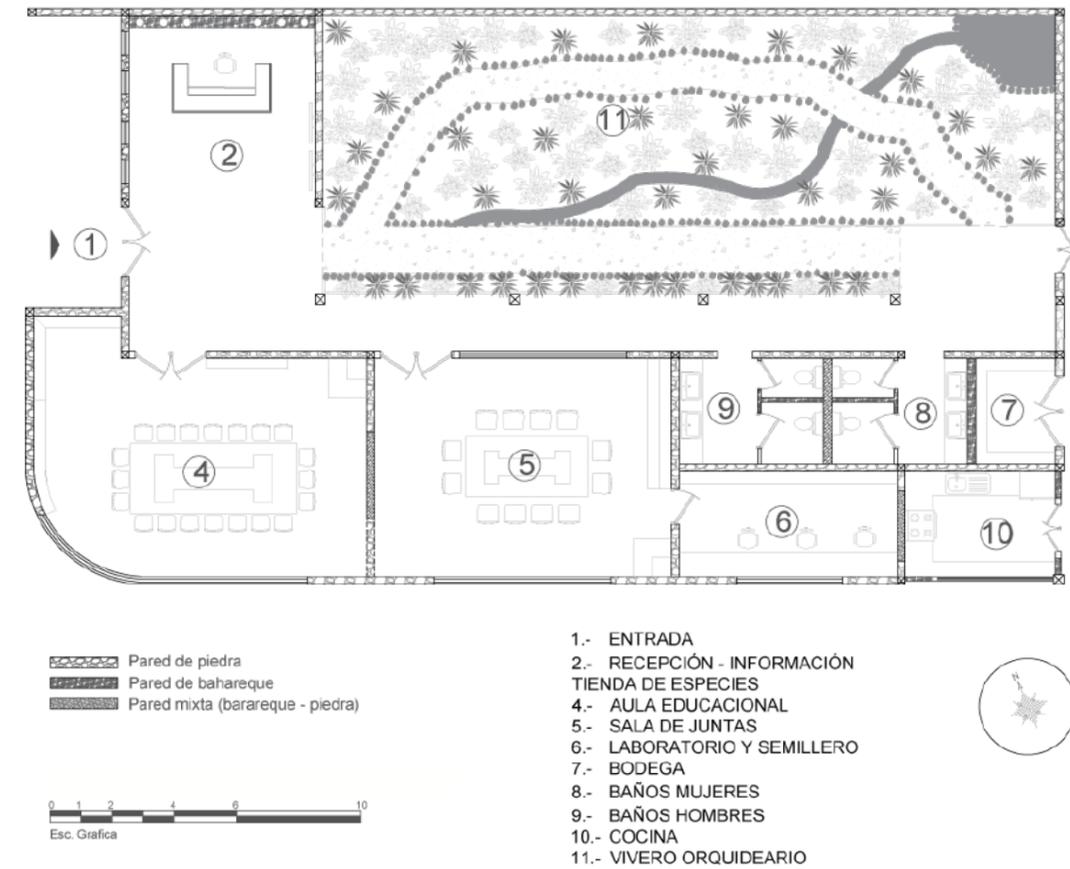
PLANTA PROPUESTA - ZONIFICACIÓN
